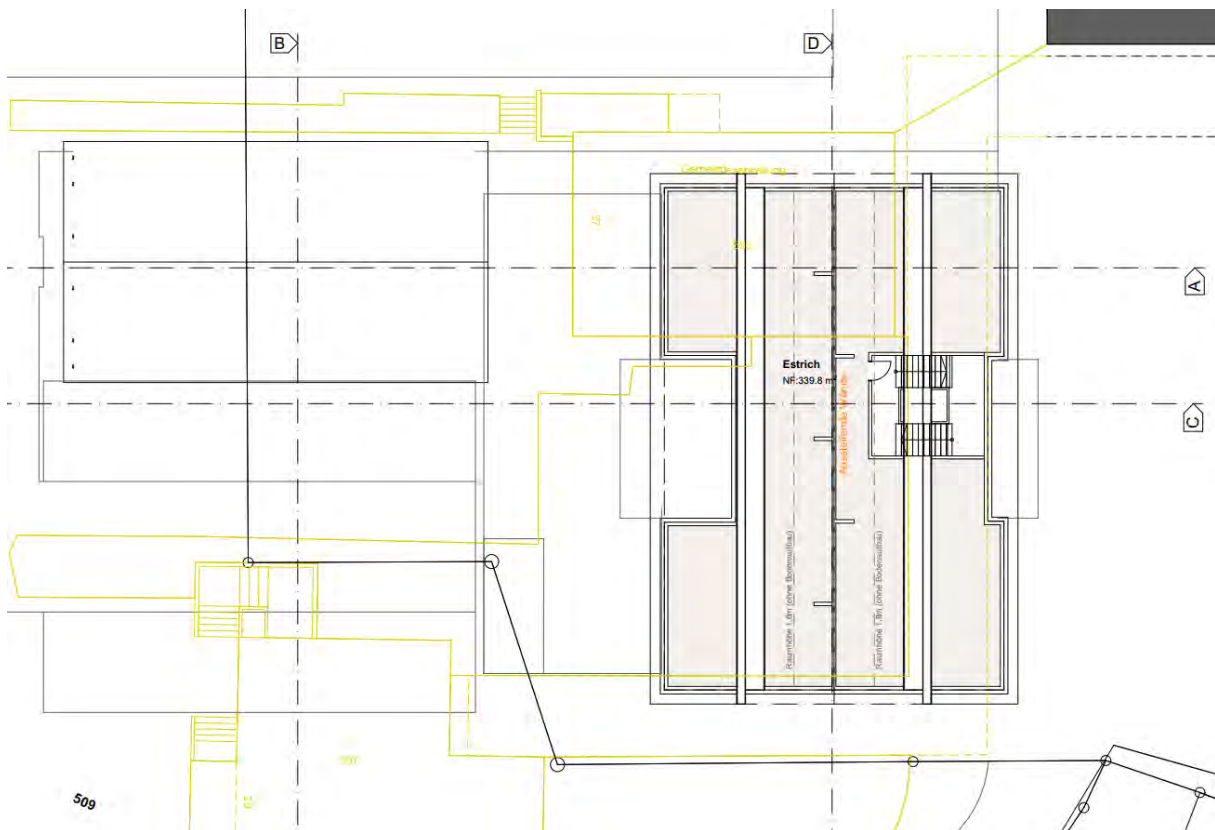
Dachgeschoss des Schulhauses (rechts)
